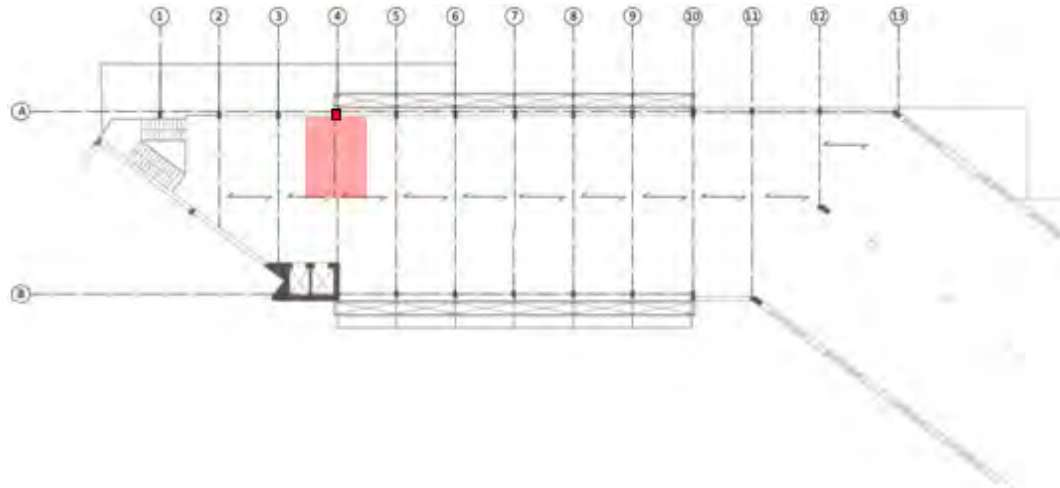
Rappresentazione schema strutturale per individuazione pilastro tipo e zona d’influenza
